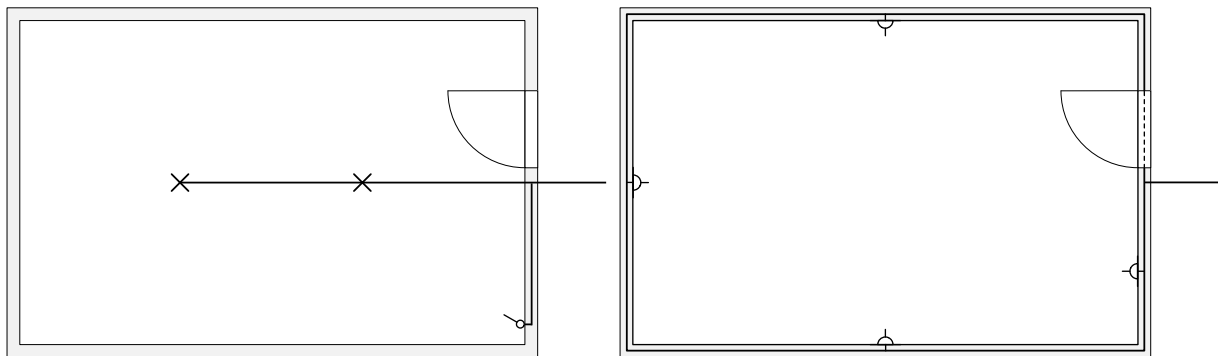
Horizontaler Schnitt - Grundschemata der Leitungsführung zu den Beleuchtungsanlagen und Steckdosen eines Standardraumes⁵¹¹
